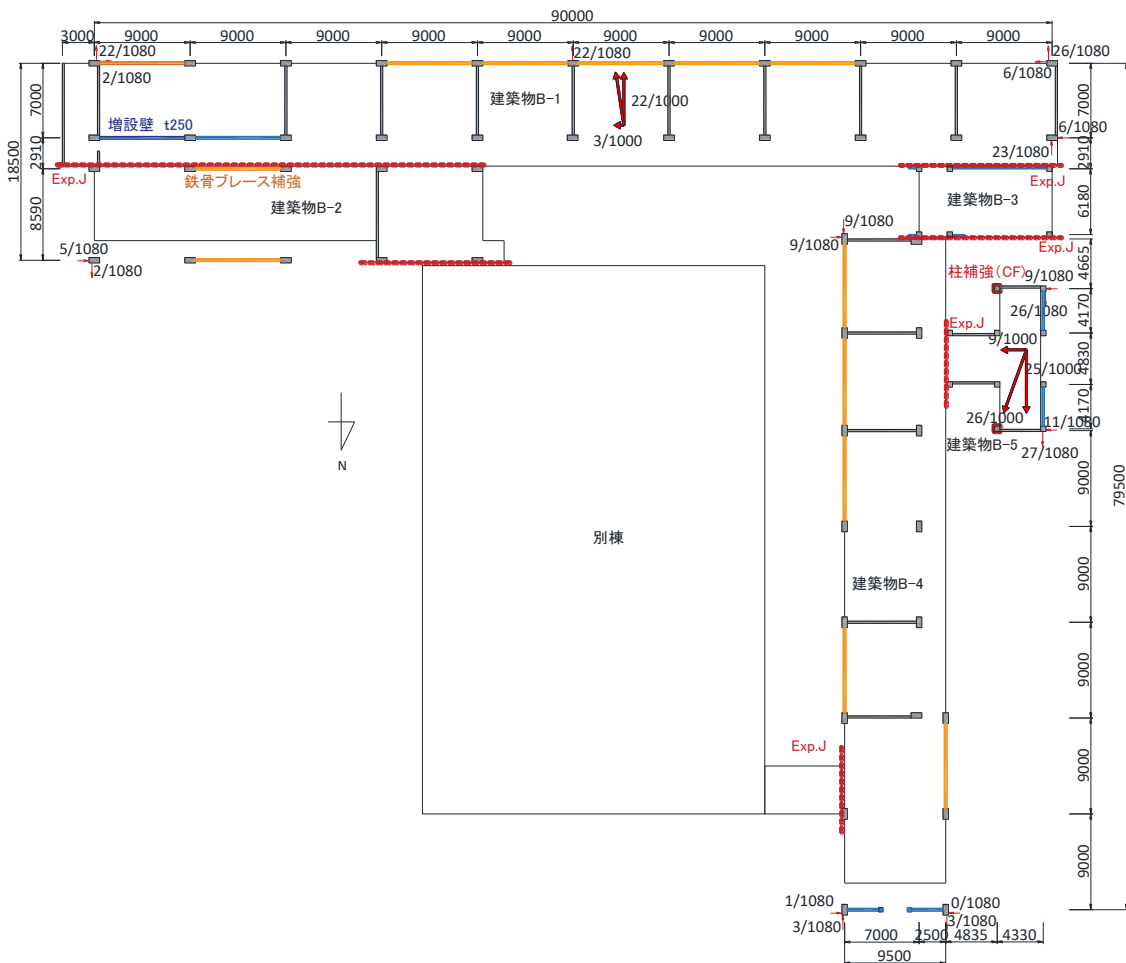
建築物 B-1～B-5 の概略平面図および傾斜計測結果
